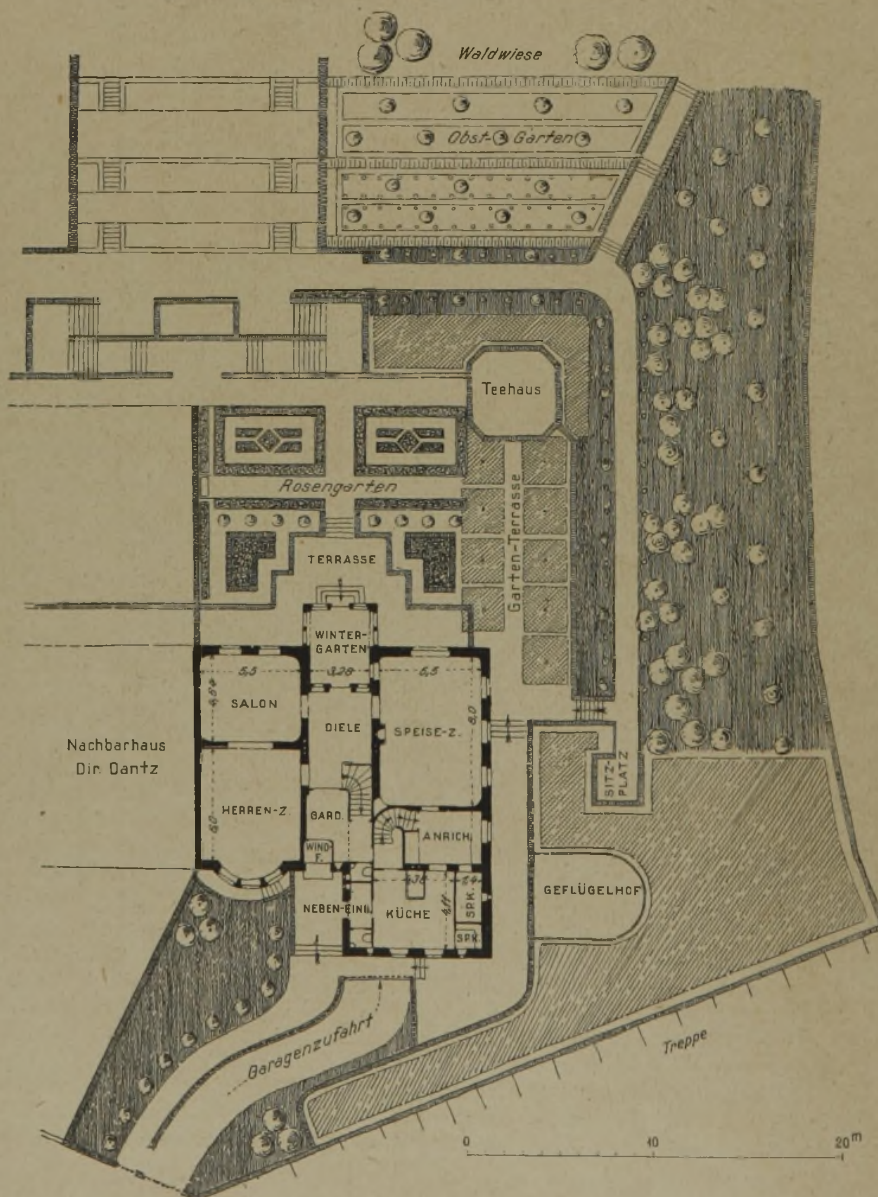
(links). Grundriß des Erdgeschosses mit Gartenanlage (1 : 400).
